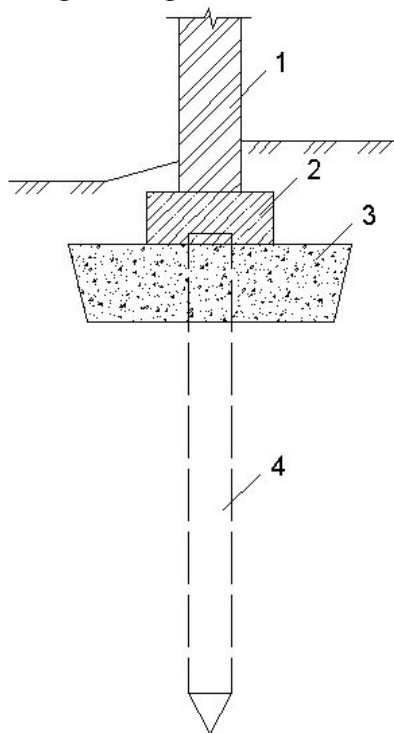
Поперечний переріз стрічкового пальового фундаменту з подушкою під ростверком: 1 – стіна будівлі; 2 – стрічковий залізобетонний ростверк фундаменту; 3 – подушка з сипучих матеріалів; 4 – залізобетонні палі
